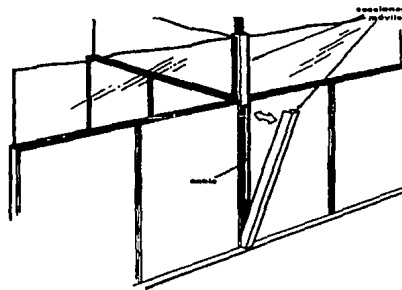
Mampara con canaleta para cablear por techo falso.
